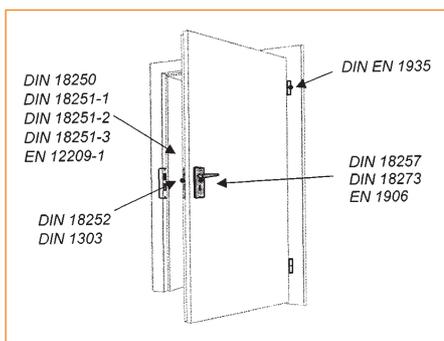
Normen und Prüfgrundlagen für Türbeschläge
